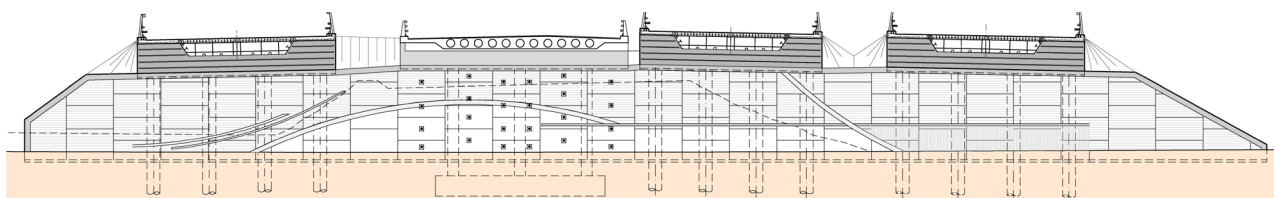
Propuesta alternativa de muro de suelo reforzado y estribos integrales para la E-10, E-11 y E-12
